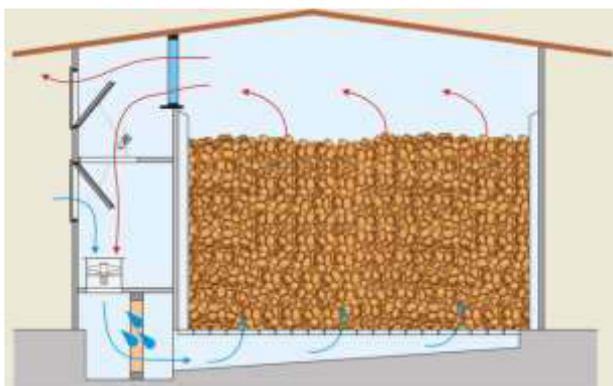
Схема хранилища с навальным способом хранения картофеля
